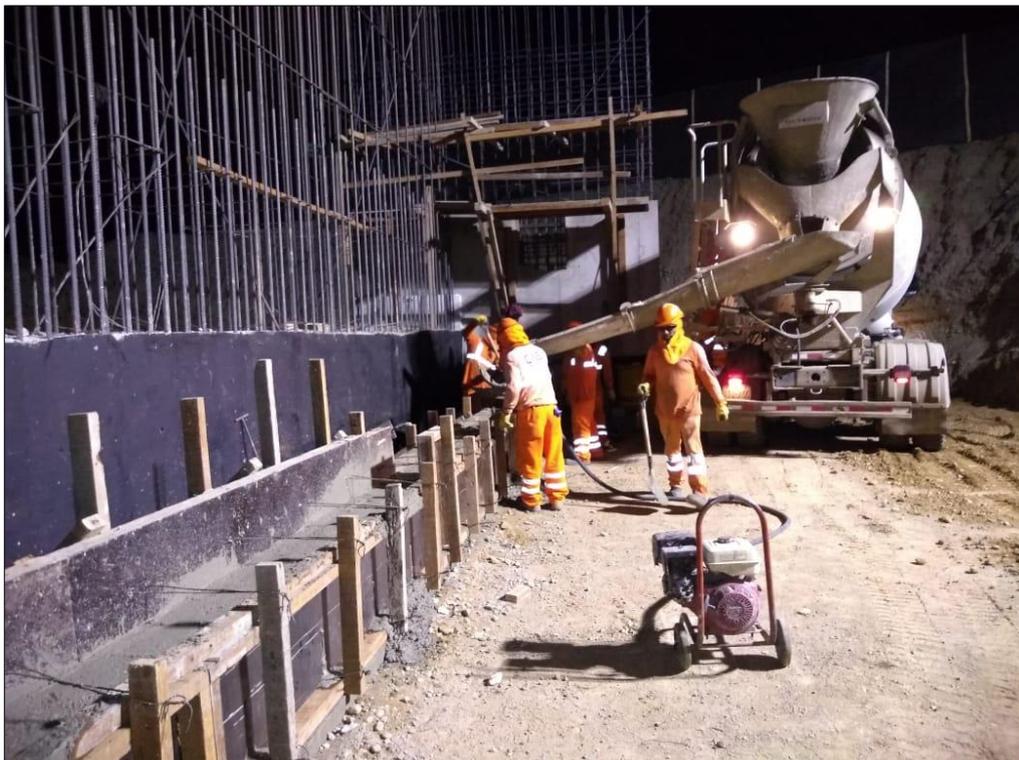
VERTIDO DE CONCRETO EN VIGA TIRANTE – LADO SUR.
